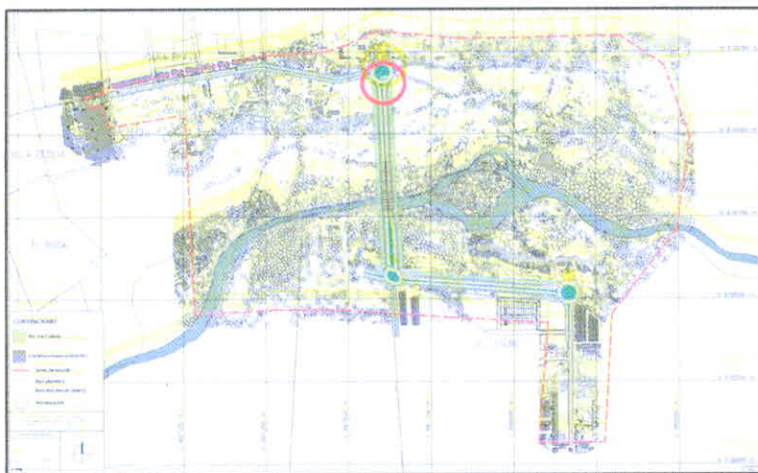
Interferencia de la red de alcantarillado de 44" con la alternativa 2
